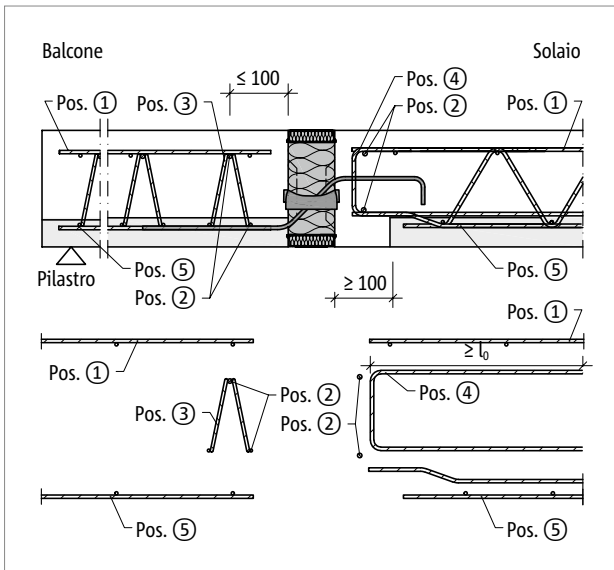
Schöck Isokorb® T tipo Q-V1 – Q-V4: armatura in opera con traliccio di supporto
